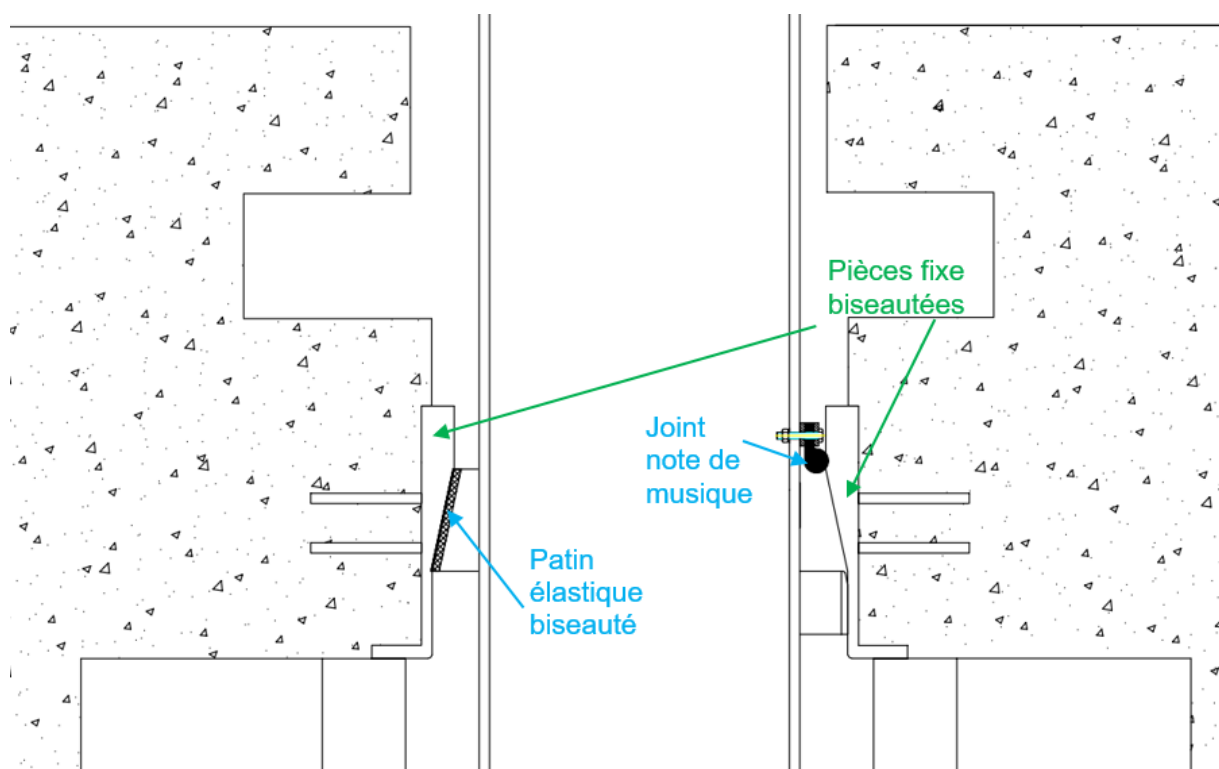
Croquis de l'extrémité de l'encoche côté Nord accueillant la porte dans l'ouvrage avec le système d'étanchéité et de plaquage du joint (angles biseautés volontairement accentués)
